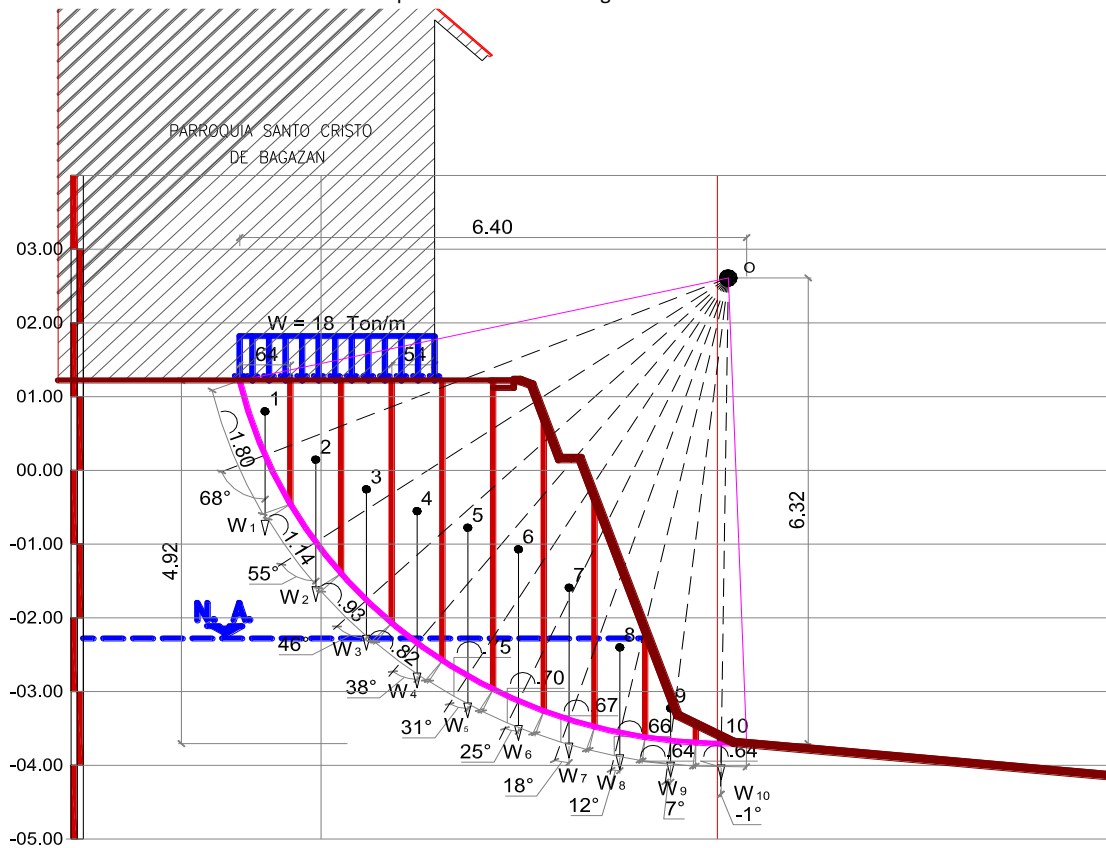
Plano de falla 1 estabilizado con el modelo propuesto.
